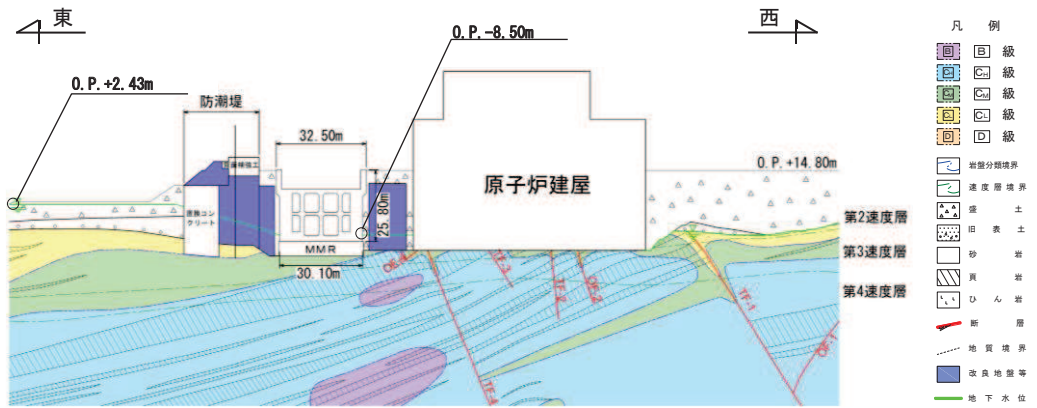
海水ポンプ室 地震時荷重算出用地質断面図
